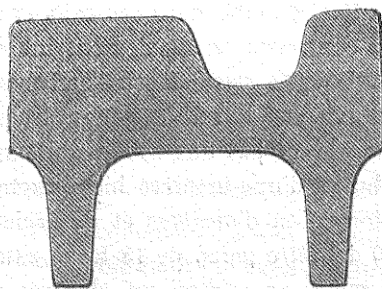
Système de tramways de M. Robinson Souttar. Section du rail. 27^k,500 au mètre courant. Échelle 1/2.
